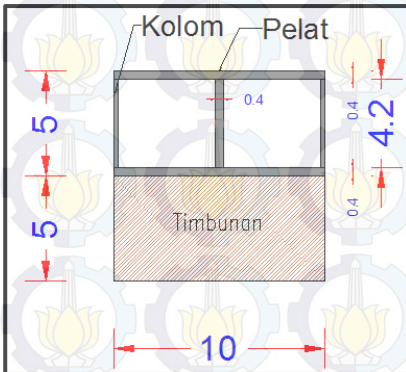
Tampak atas denah *Slab Column Slab
